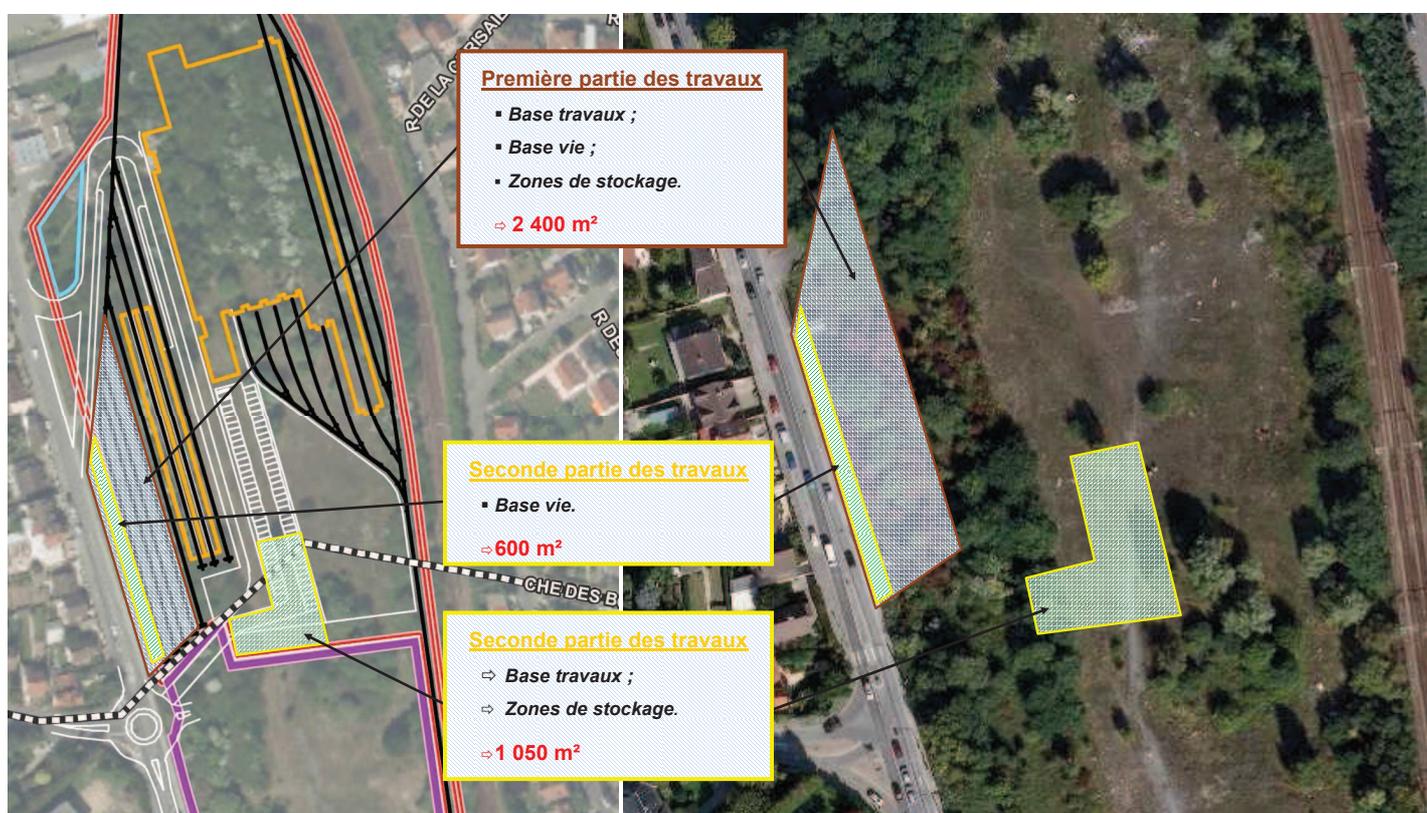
Localisation des installations de chantier (Source : SYSTRA, 2013)
